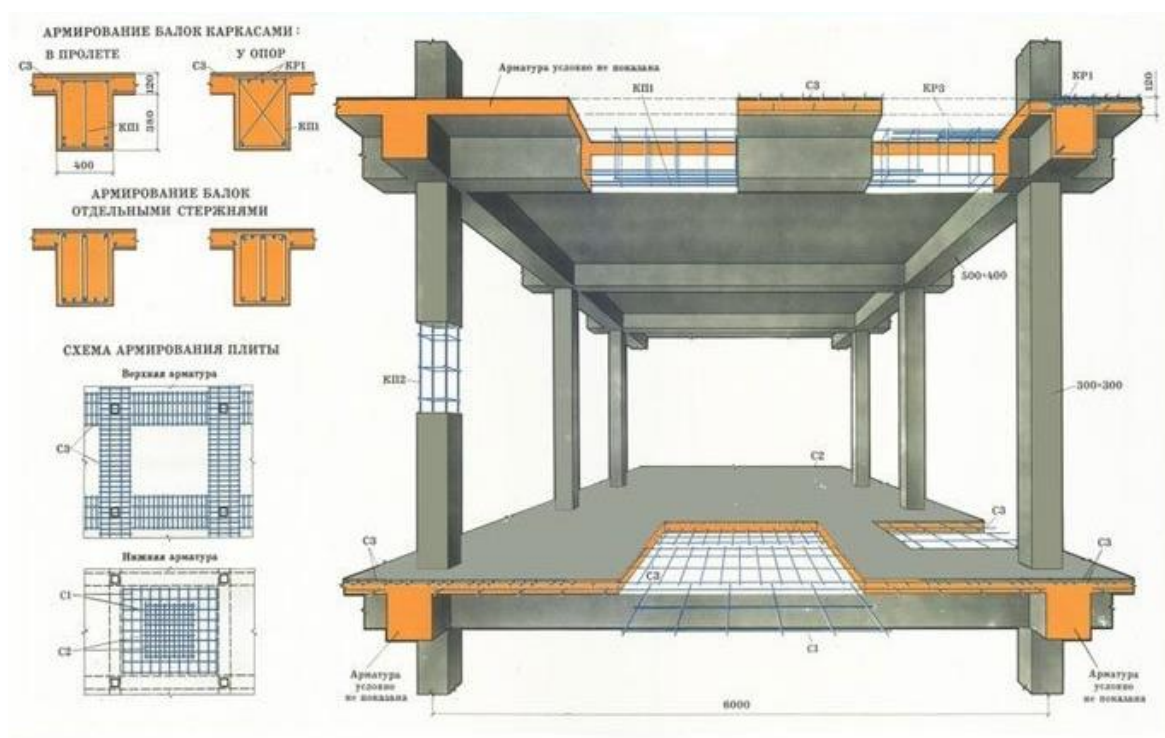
Пространственная модель и армирование монолитного ребристого перекрытия
